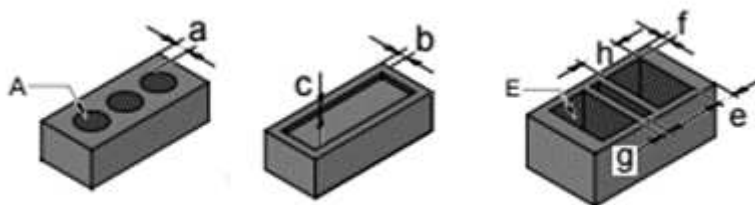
Geometria da seção transversal de blocos cerâmicos estruturais americanos
